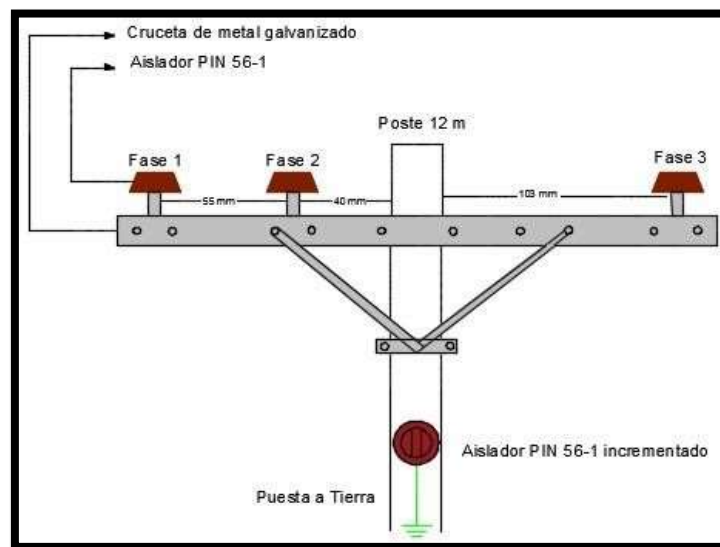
Incremento y ubicación de aislador ANSI 56-1 en estructura PS3
